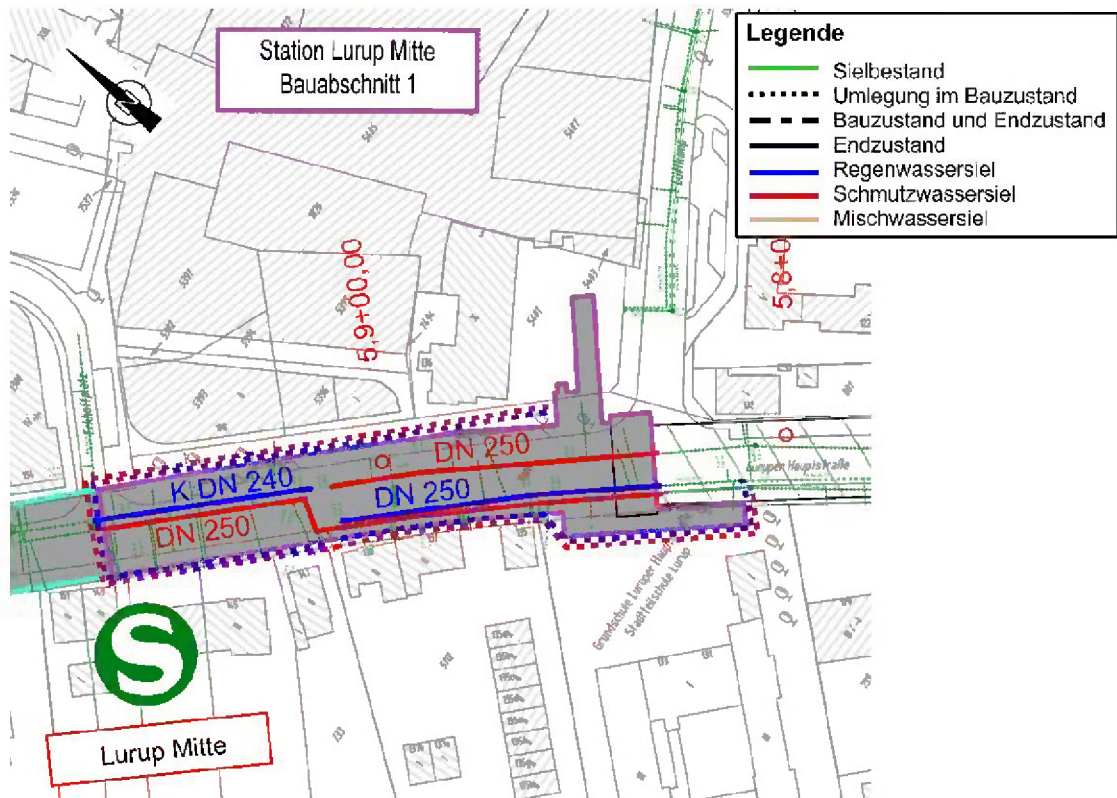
Sielplan Baubereich Station Lurup Mitte (I), Bauabschnitt 1 (Stand 04.2019)
